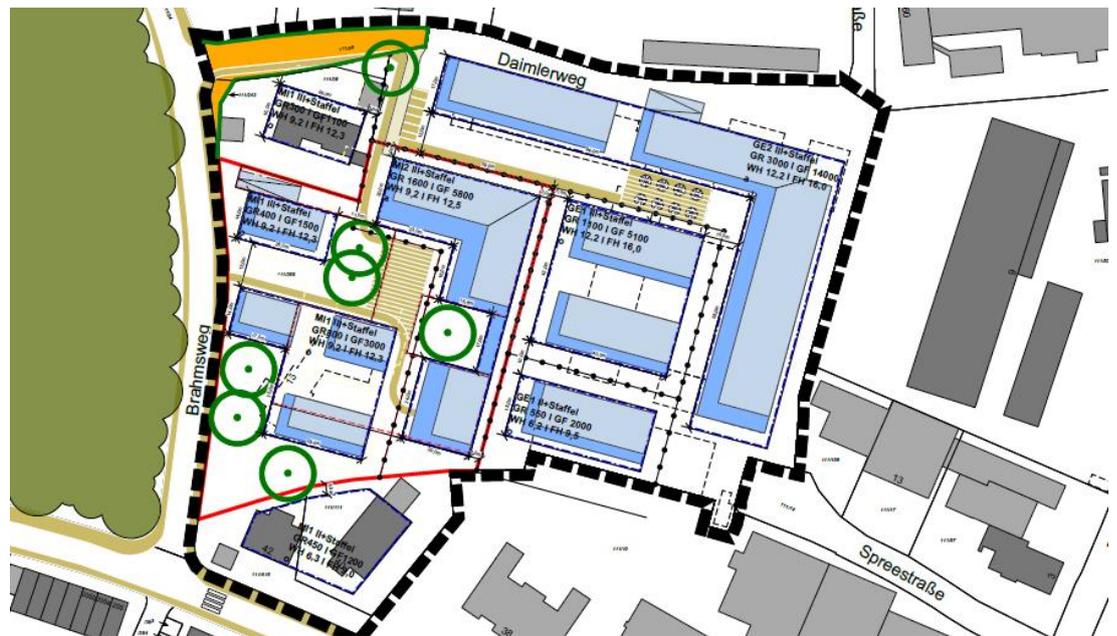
Städtebaulicher Entwurf mit angestrebtem Art und Maß der baulichen Nutzung, PV
